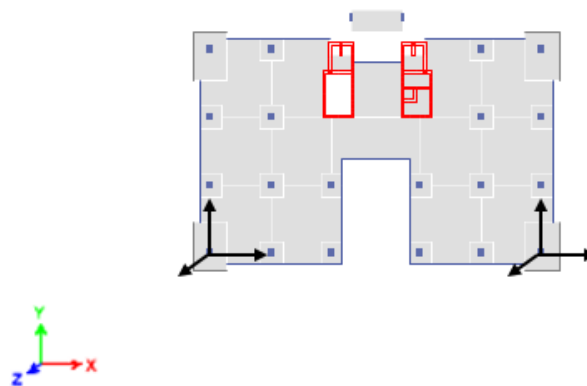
Esquema de ubicación de sensores en la Tercera, Quinta y Séptima planta de la estructura. Instrumentación Tipo 4.
